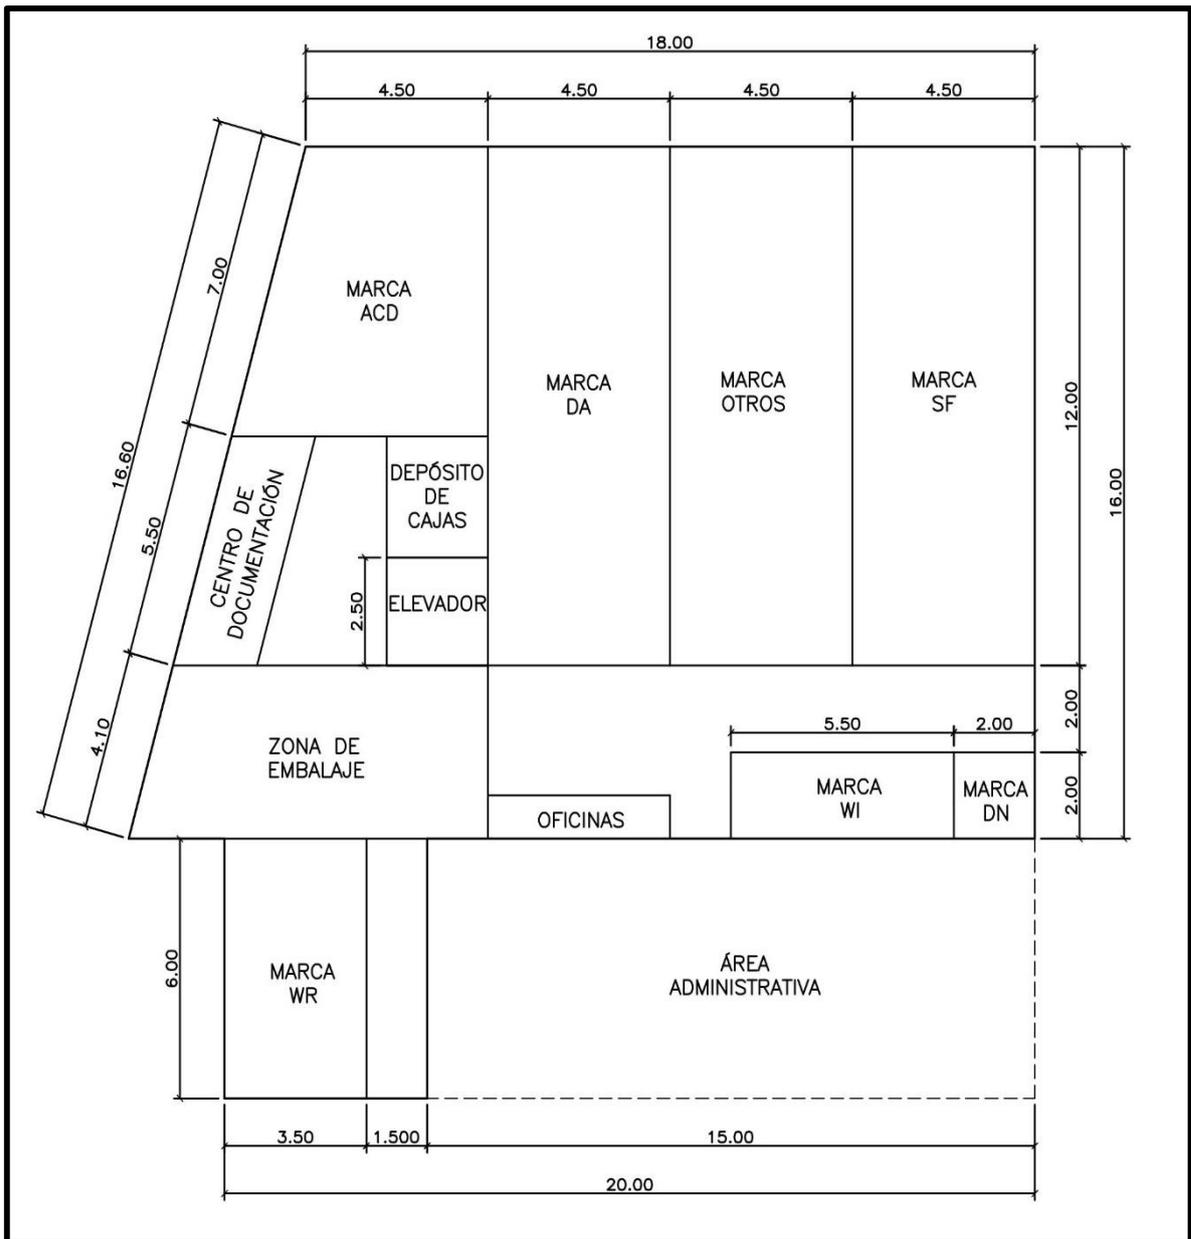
Layout actual del primer piso del almacén. Fuente: Elaboración propia
